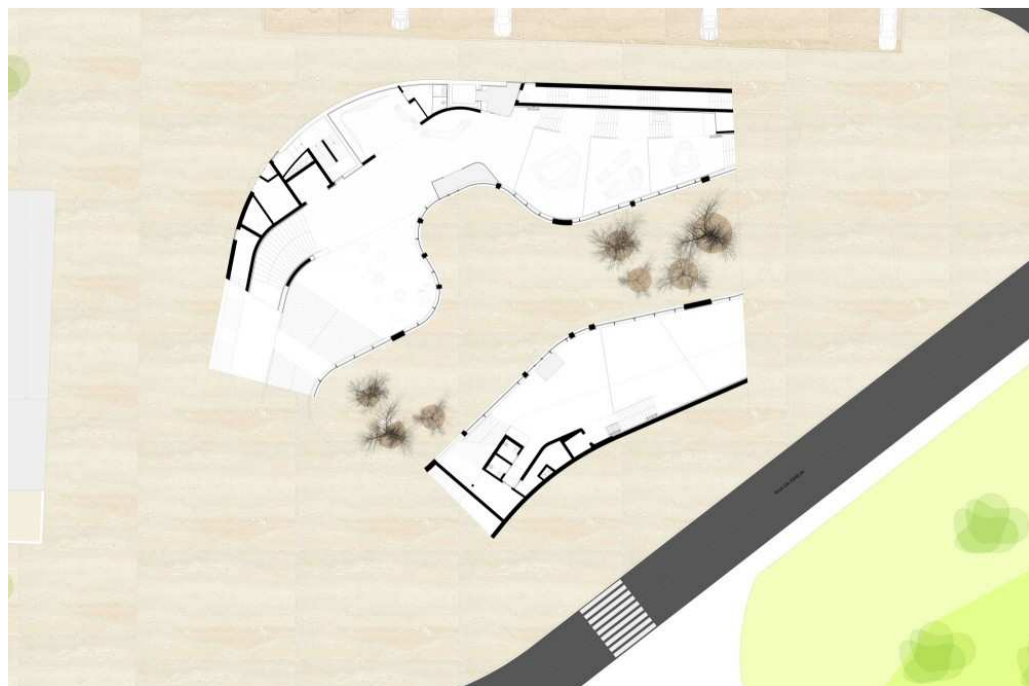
Planta Baixa | Pavimento Térreo. (FONTE ARCHDAILY, 2011).
